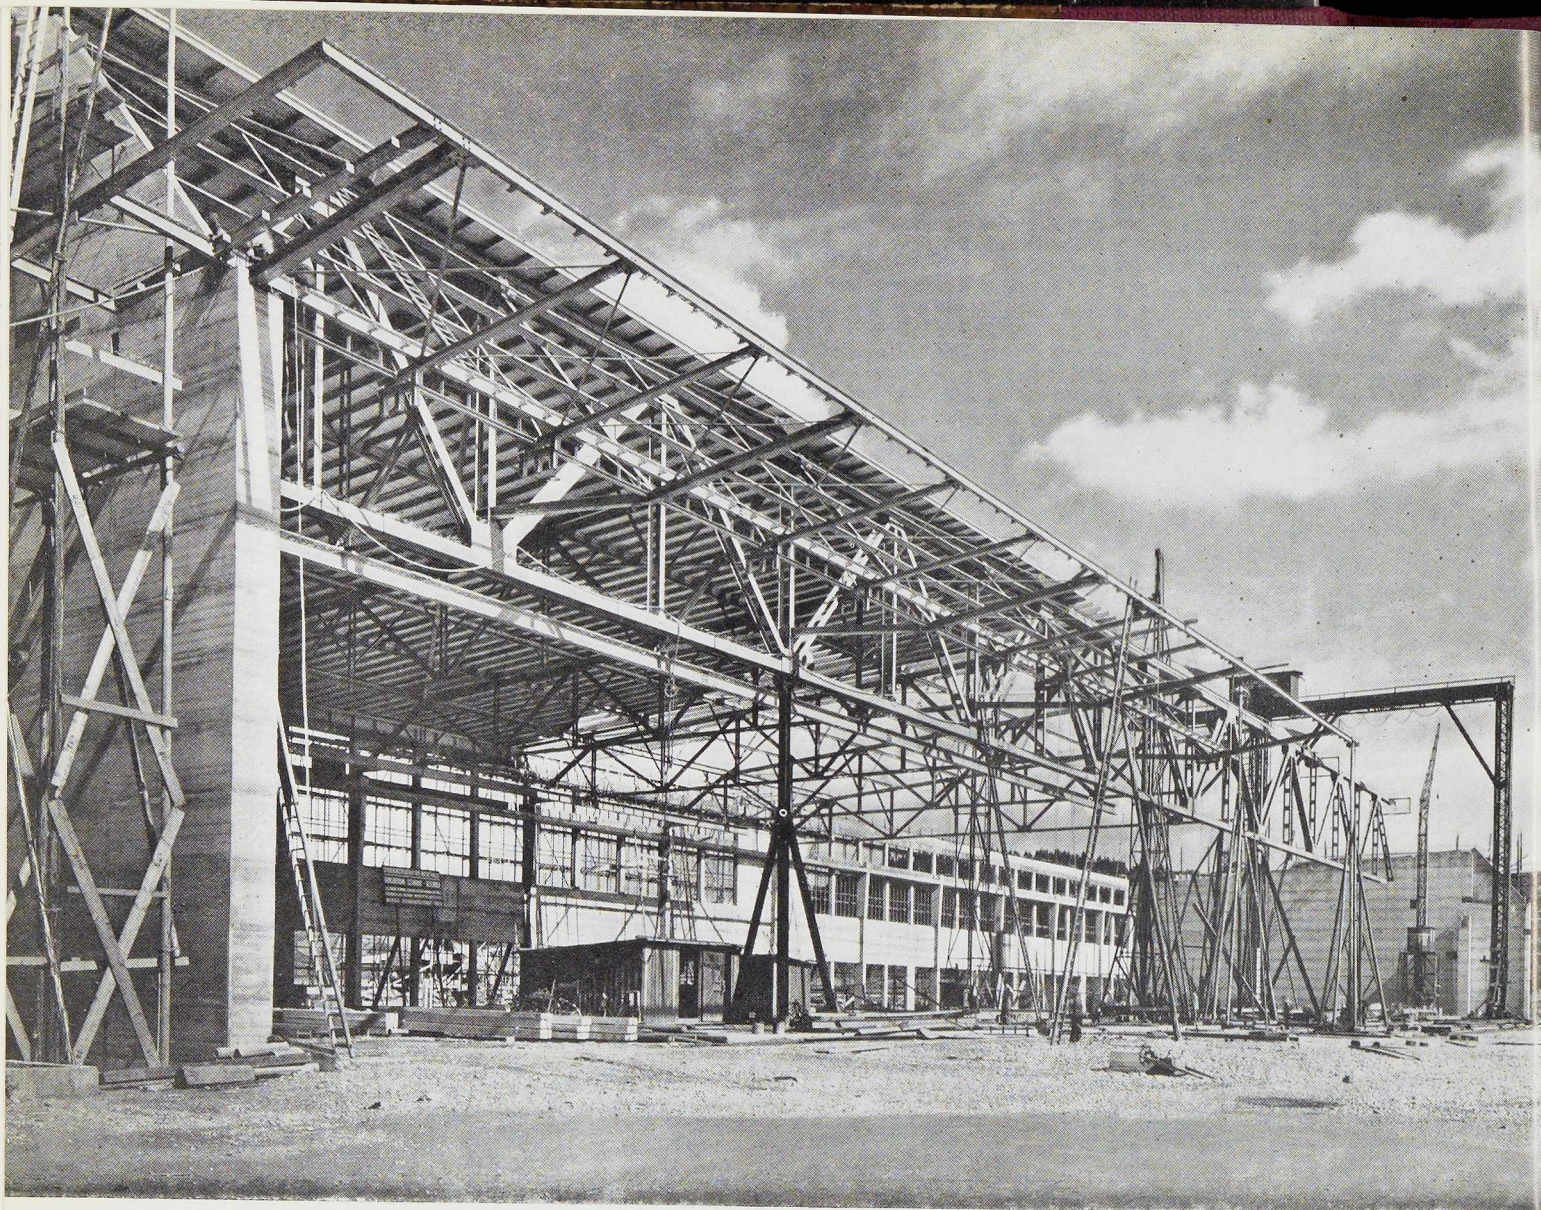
Vue d'ensemble des travaux de construction du hangar de Kloten-Zurich, prise en juillet 1948
